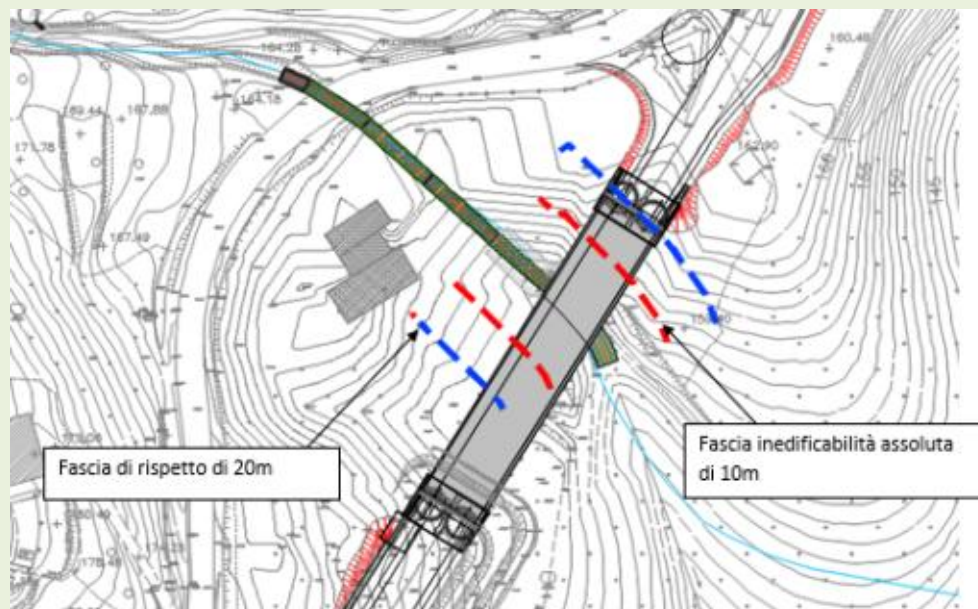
Fasce di inedificabilità e di rispetto impluvio Viadotto Garbarini – Nuovo layout di progetto
